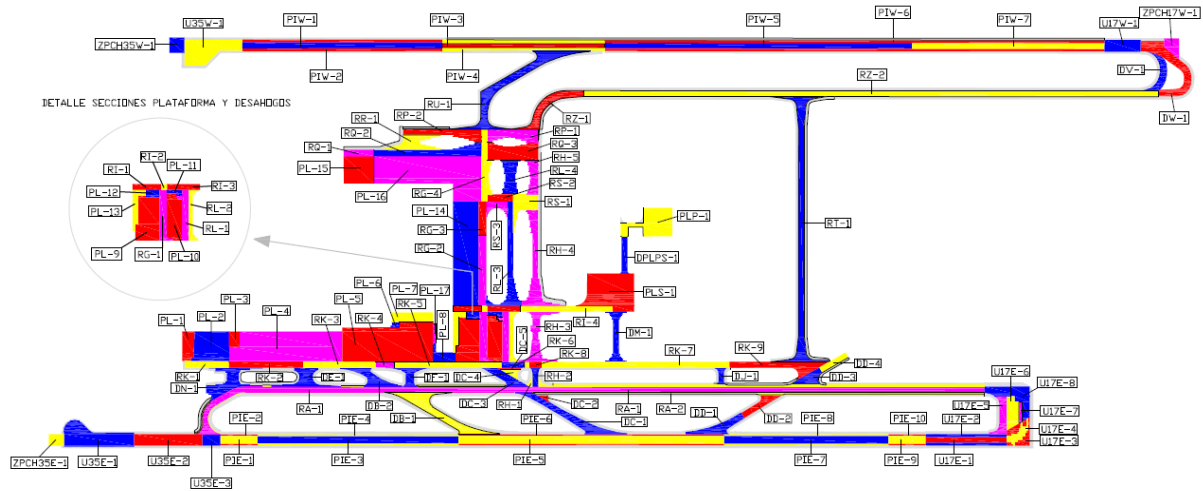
Plano esquemático secciones del Aeropuerto Arturo Merino Benítez.
